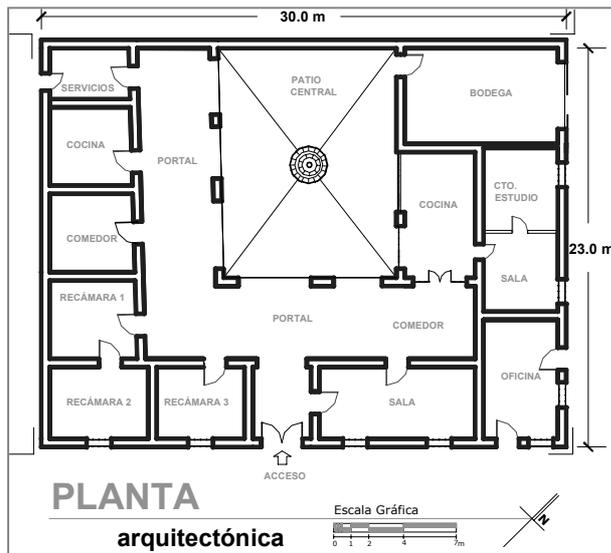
Planta Arquitectónica. Vivienda vernácula.
